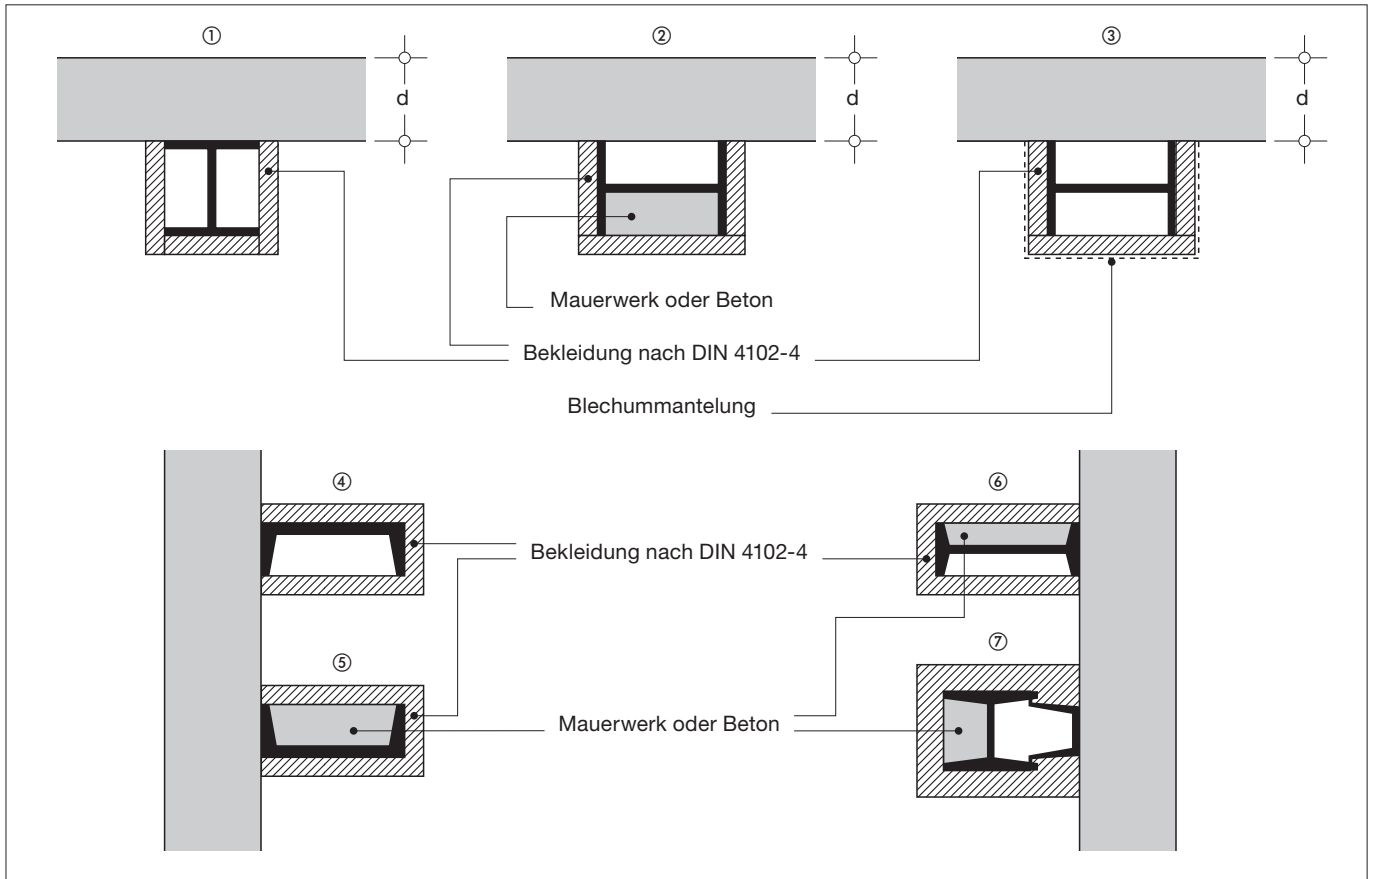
Bekleidung (Schema) von Stahlstützen (Ausführungen 1 bis 3) und Stahlriegeln (Ausführungen 4 bis 7) nach DIN 4102-4; als Bekleidung nach Abschnitt 6.2 und 6.3 der DIN 4102-4 kommen u. a. Porenbetonsteine nach DIN V 4165 und Porenbetonbauplatten nach DIN 4166 zur Anwendung
